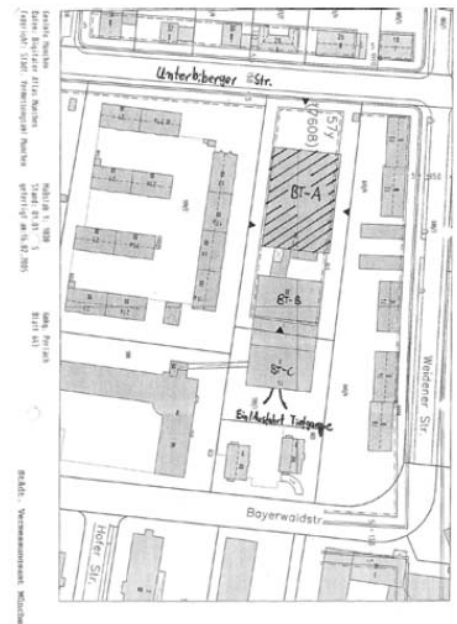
Ansicht und Lageplan des Kraft Foods Gebäudes in München
